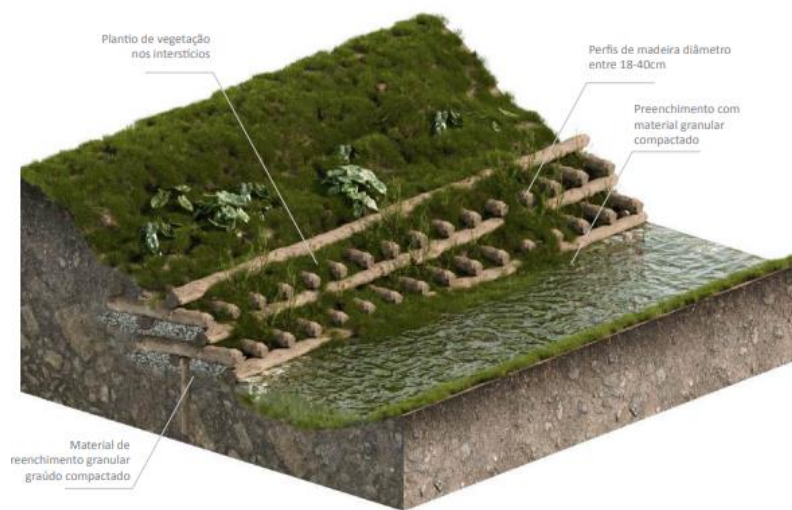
Muro de suporte vivo em madeira tipo cribwall (Fonte: Guajava. Adaptado de Helgard Z., 2007).
